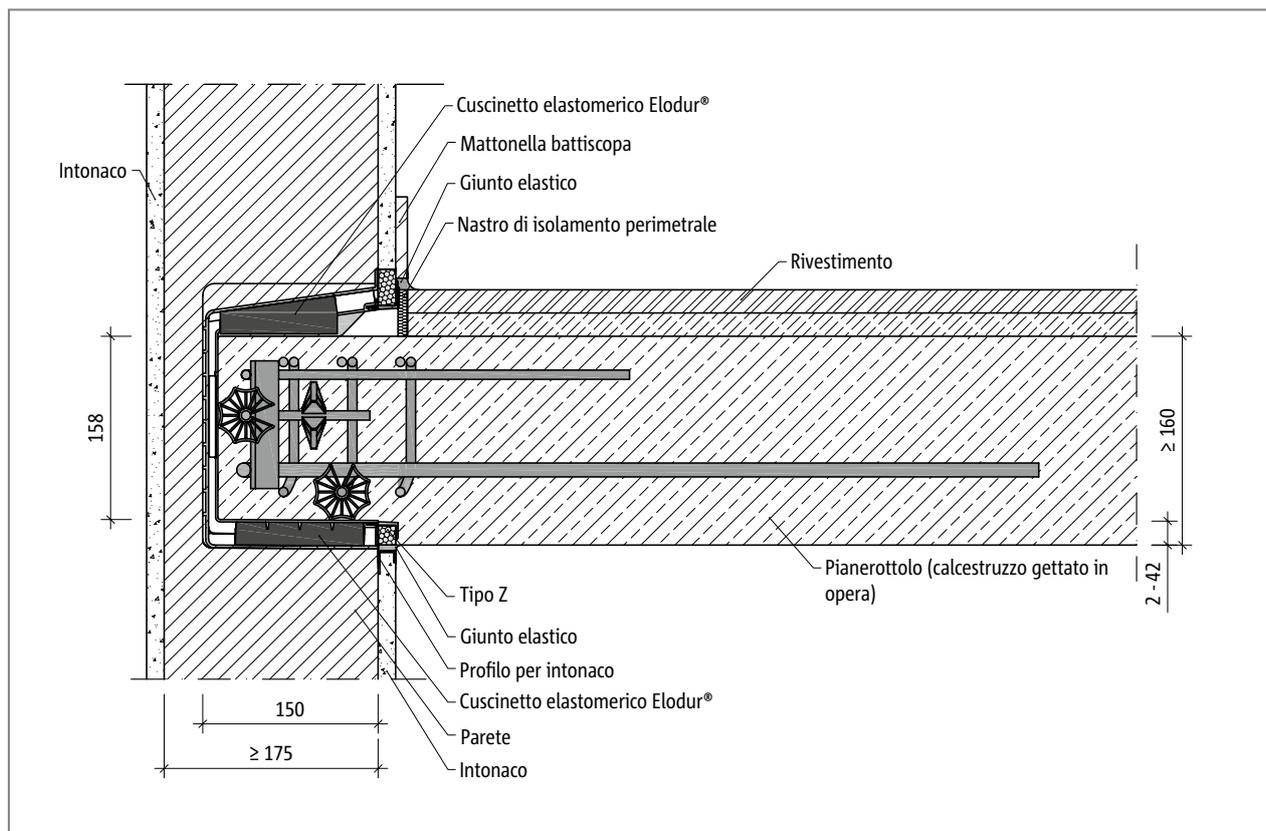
Schöck Tronsole® tipo Z-V+V-T: sezione costruttiva - Pianerottolo in opera
